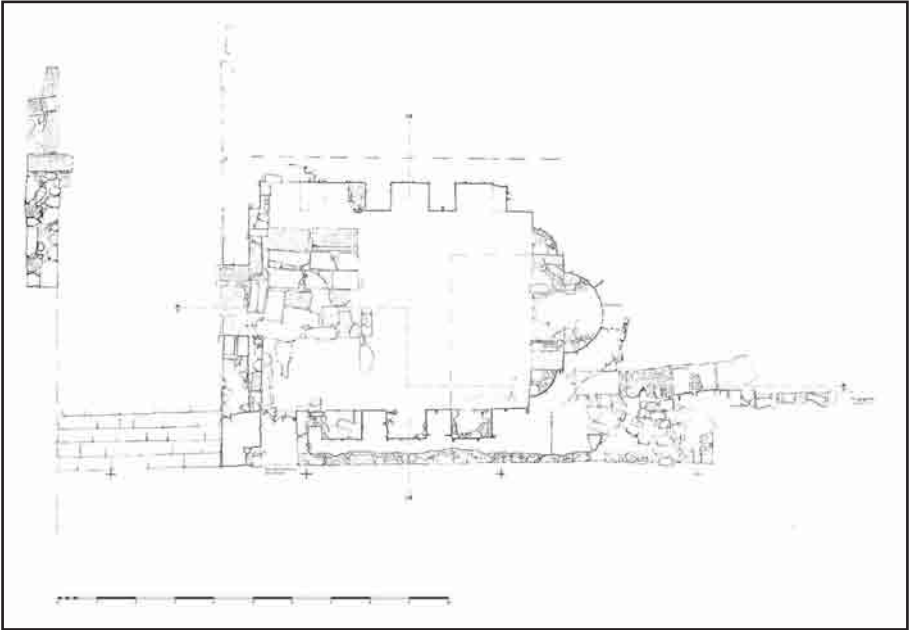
Priene 2008. Agora-Kapelle. Grundriss
